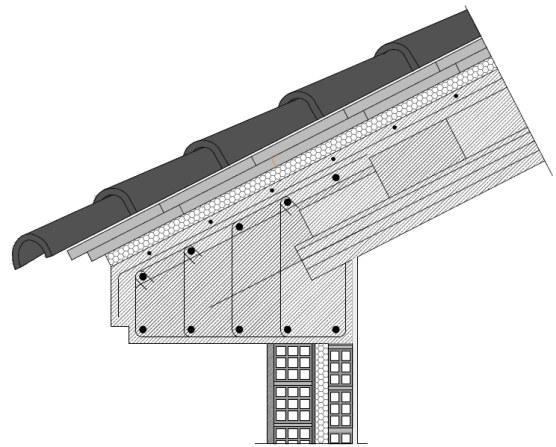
Fachada-Cubierta. Zona este. Estado rehabilitado.
